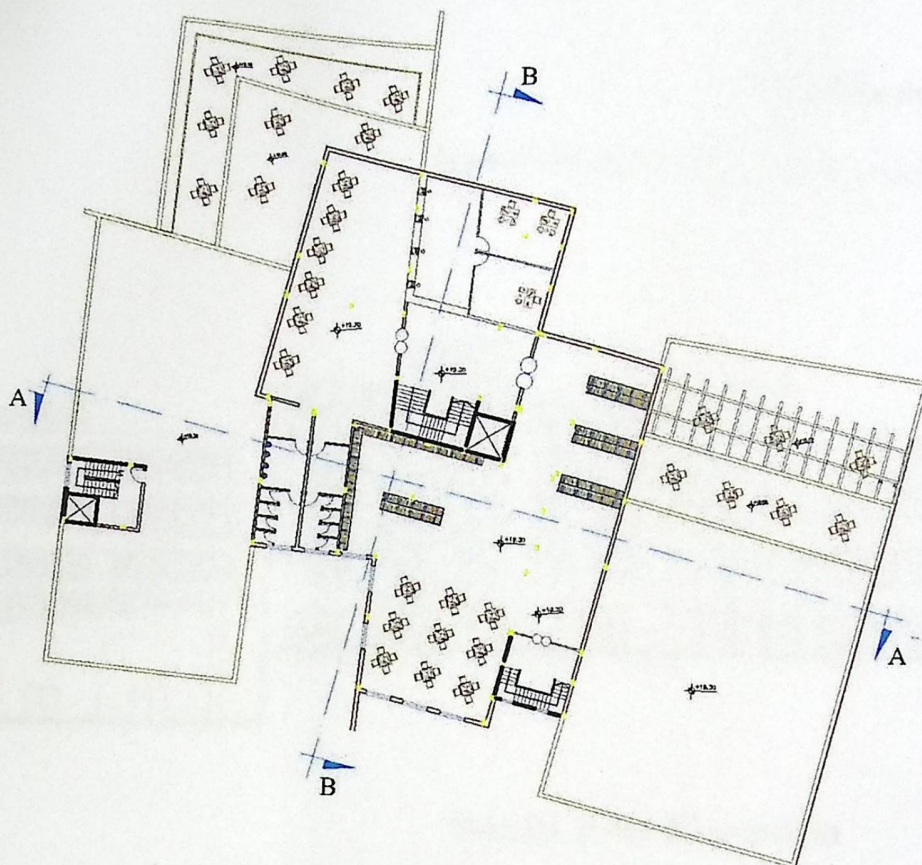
المسقط الأفقي للطابق الثالث.
